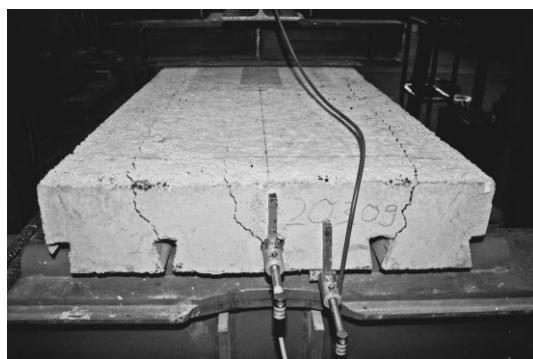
Aufspalten der Verbunddecken mit Leichtbeton infolge Längsrisssbildung.
